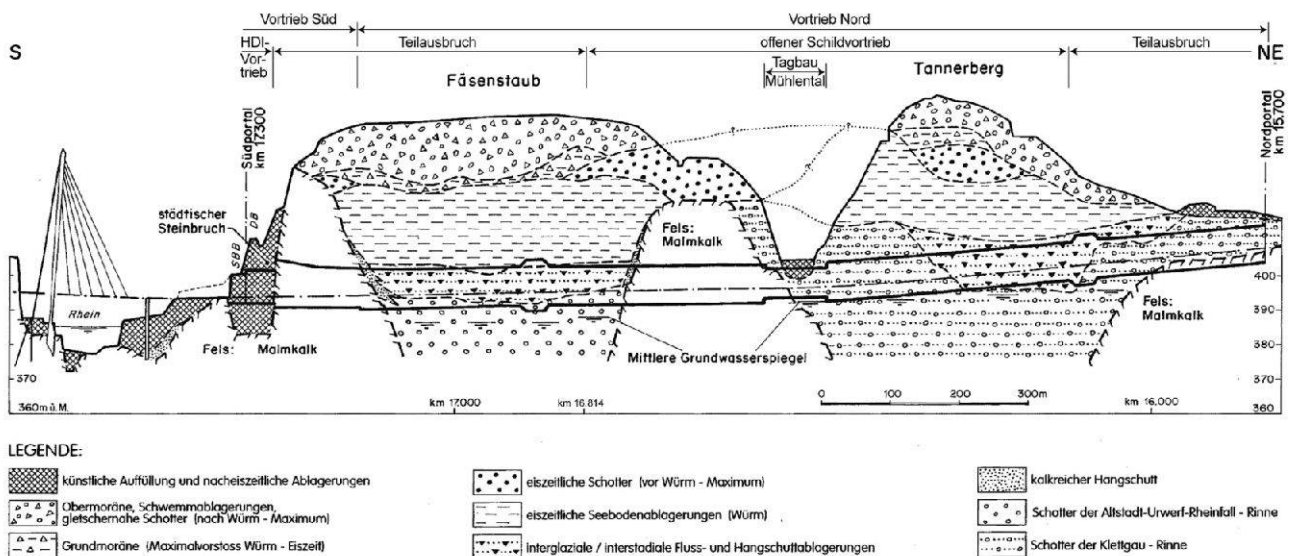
Geologisches Befundprofil N4 Fäsenstaubtunnel, Schaffhausen, 5-fach überhöht.
